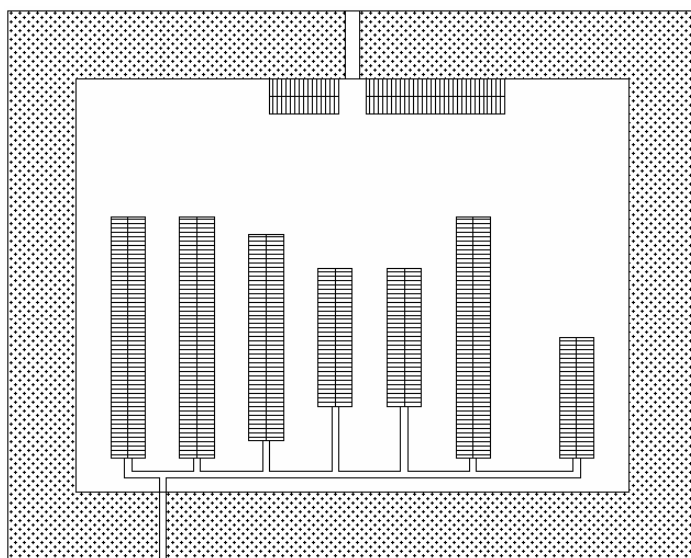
Sistema modular vertical de disposição das instalações (adaptado de TEIXEIRA, 1997)
